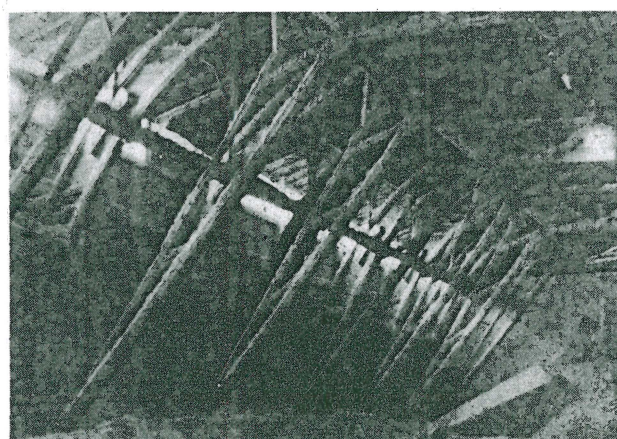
Salzablagerungen auf Baukonstruktionsteilen in einer Kalilagerhalle
